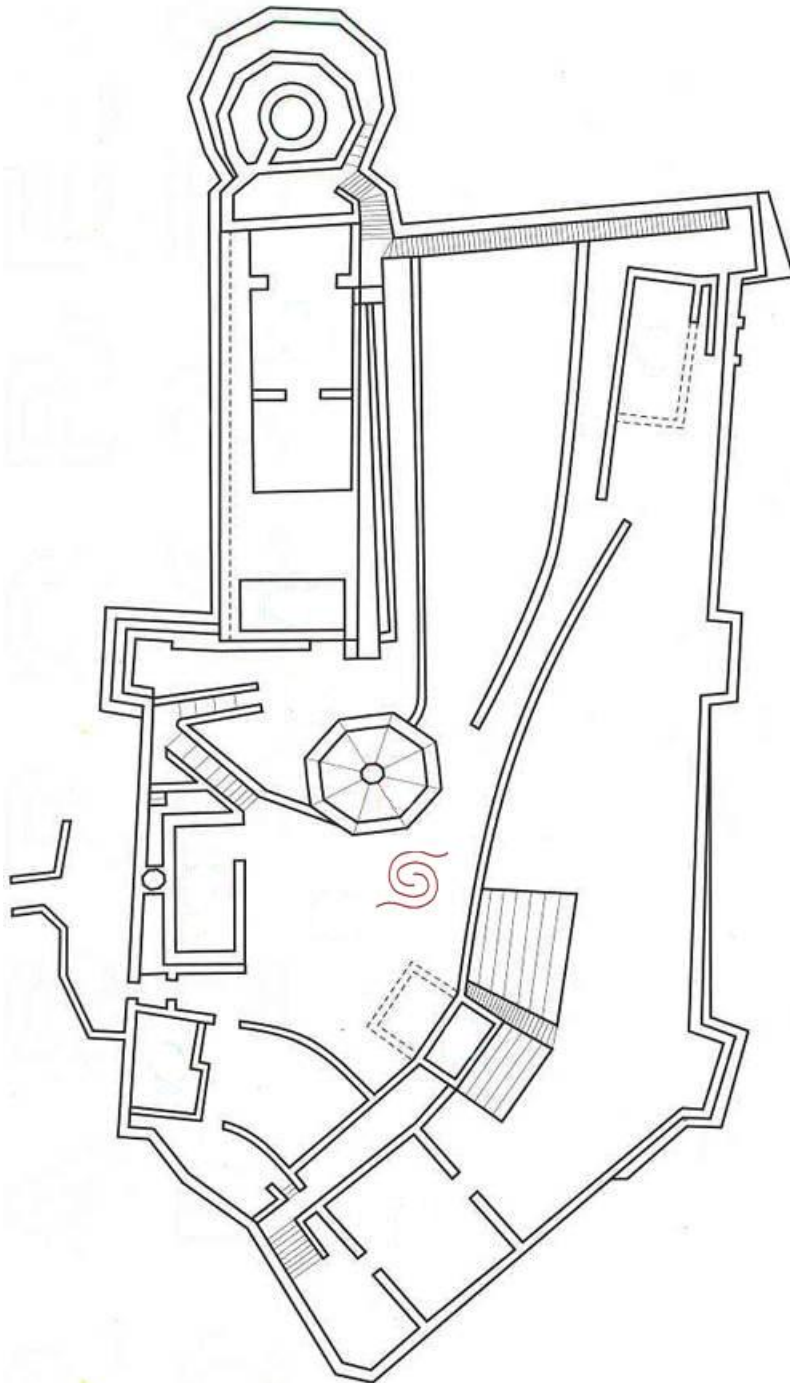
Alte Festung Travnik Grundriss und Lage des Pavillons
